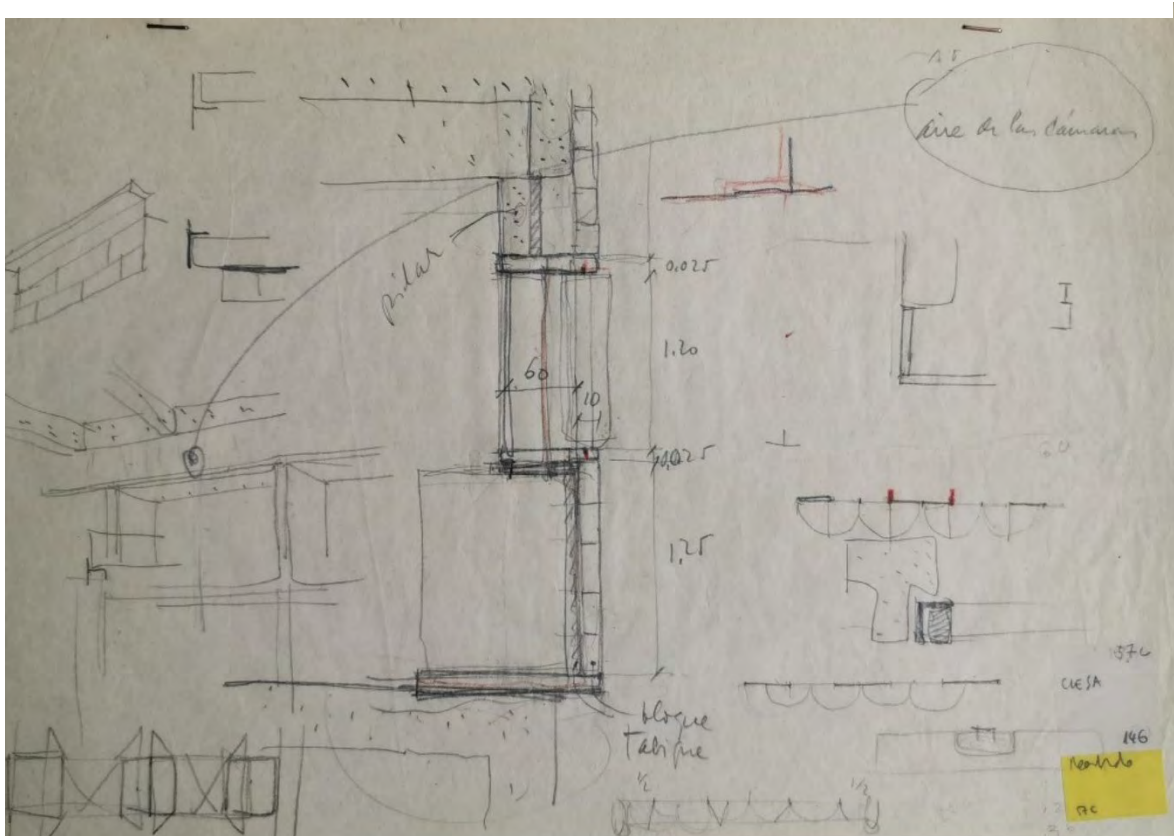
Detalles carpintería exterior. La sección vertical y el apunte en perspectiva corresponden a solución similar a la de la figura A51. Se apuntan también formas de practicabilidad de ventanas (similar a las empleadas en fachada oeste) y solución de perfil oculto fijadas a montantes de hormigón. Fundación A. de la Sota.
